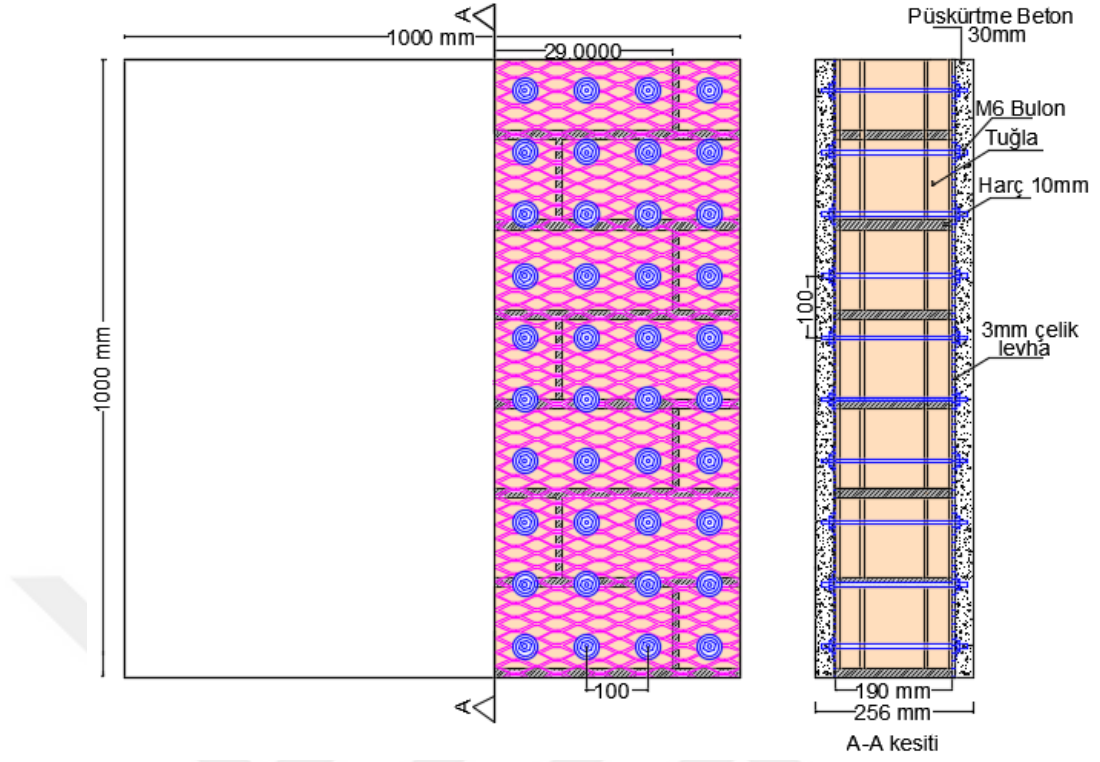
MBWS 3,0-400 Deneme elemanı
